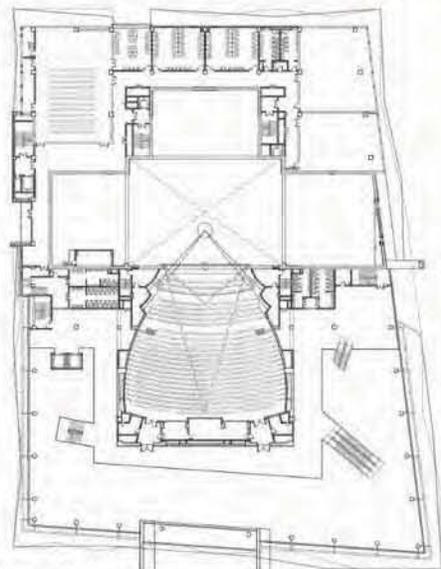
Planta arquitectónica del conjunto Bayuquan.
